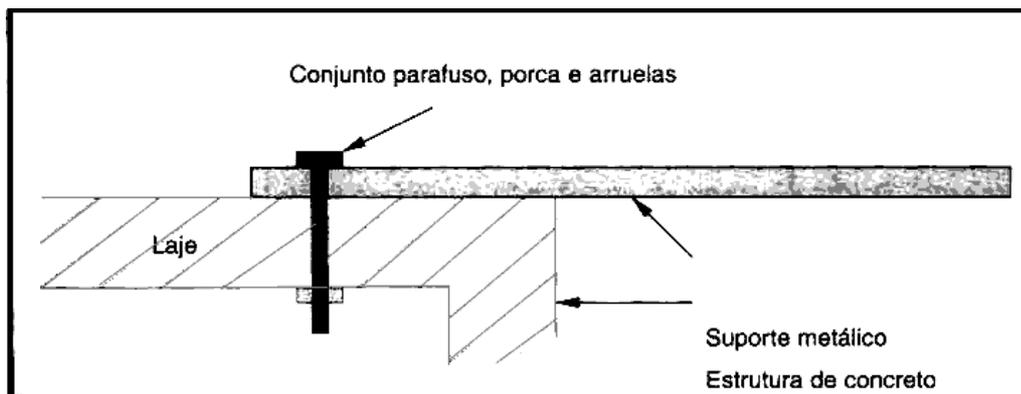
fixação do suporte metálico na laje (ARAÚJO, 2002)
